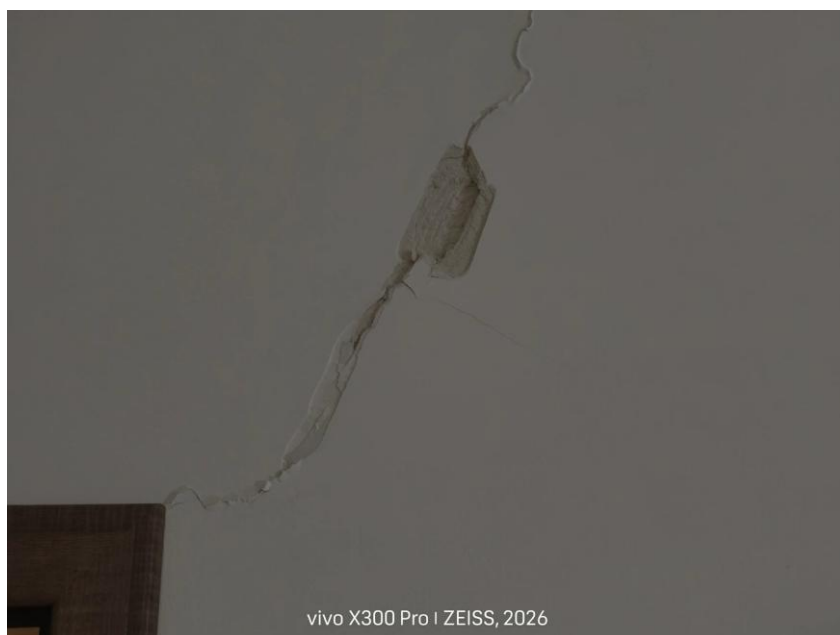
Detail nejporušenějšího úseku a pokračování trhliny k hornímu rohu zárubně (vlevo dole).
